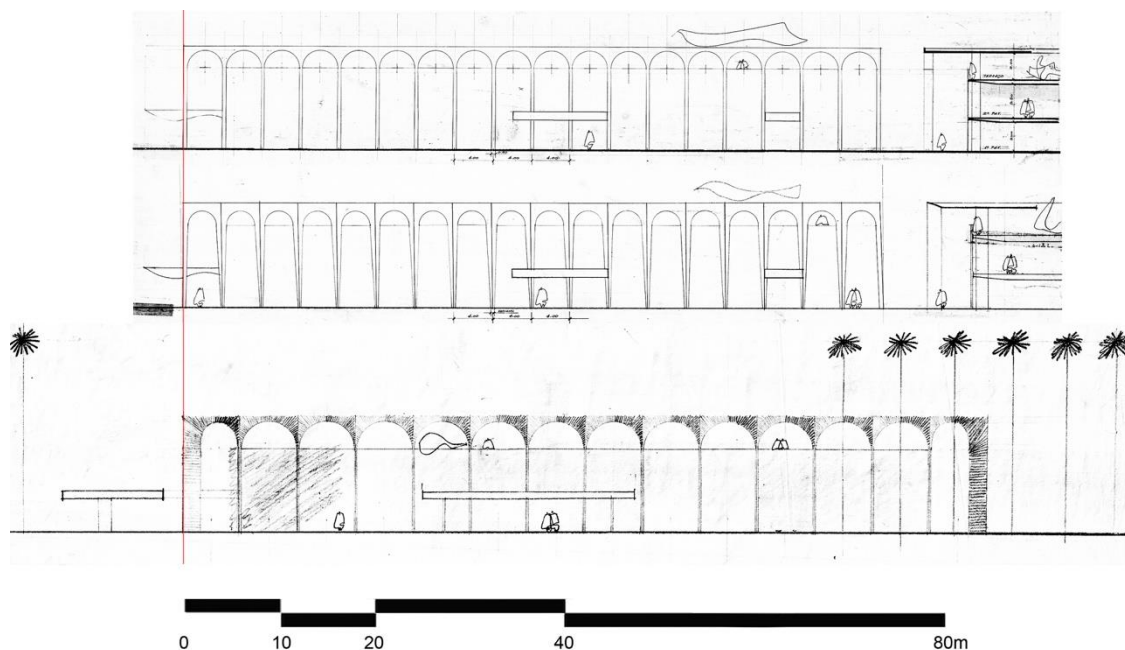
Versões de fachadas apresentadas em fevereiro de 1963 reunidas em um único desenho. Adaptação dos desenhos da Companhia Construtora Pederneiras elaborados por Milton Ramos, presentes no Arquivo Público do DF.
